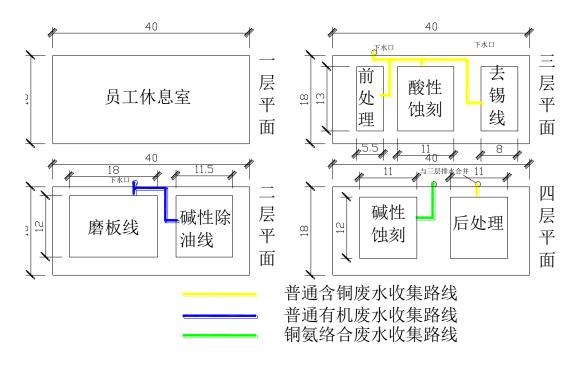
(c) 3#楼各层车间平面布置图(单位: m)
